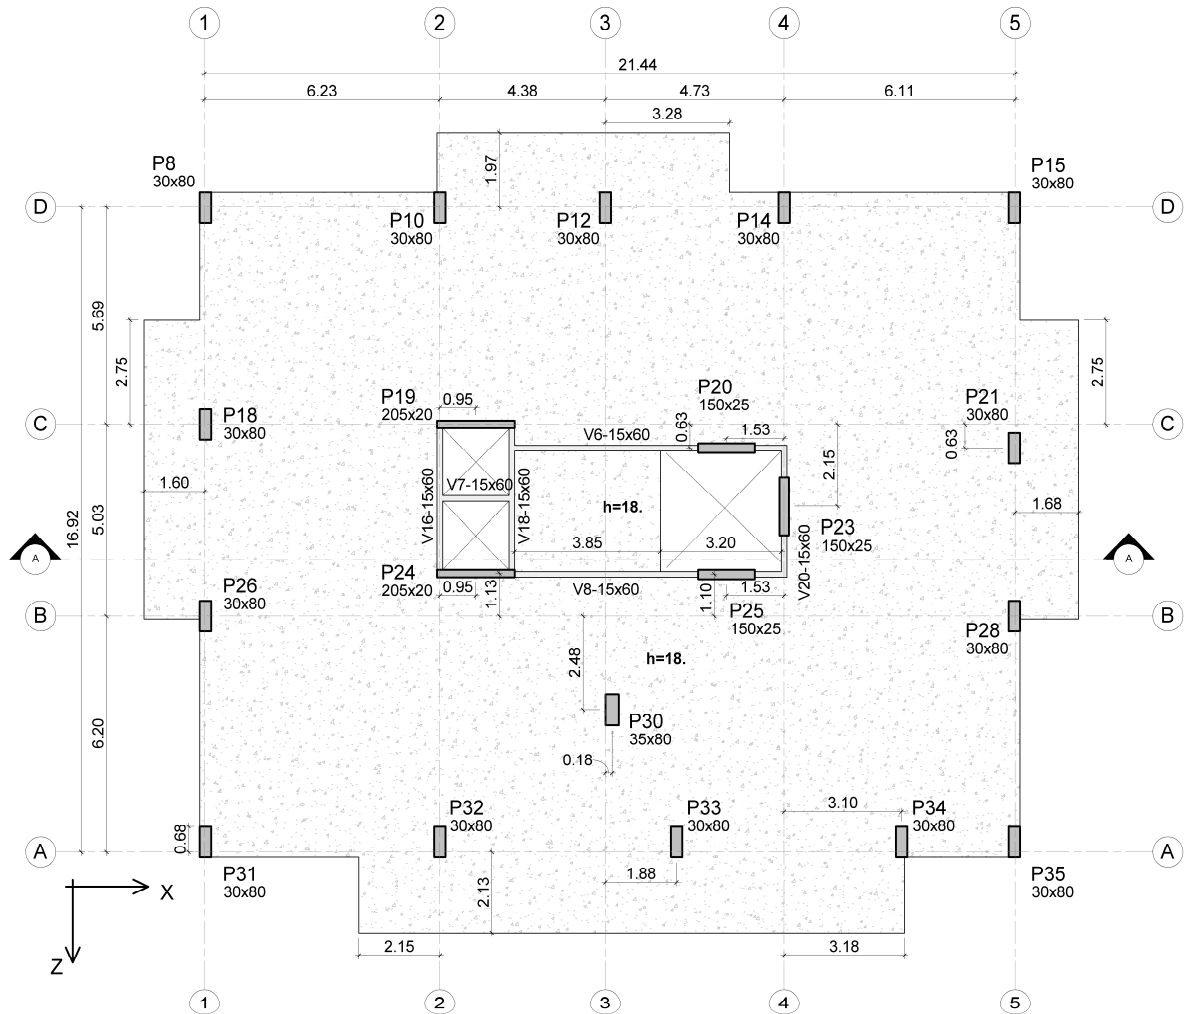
Planta estrutural - Modelos C e D - Unidades em metros.
